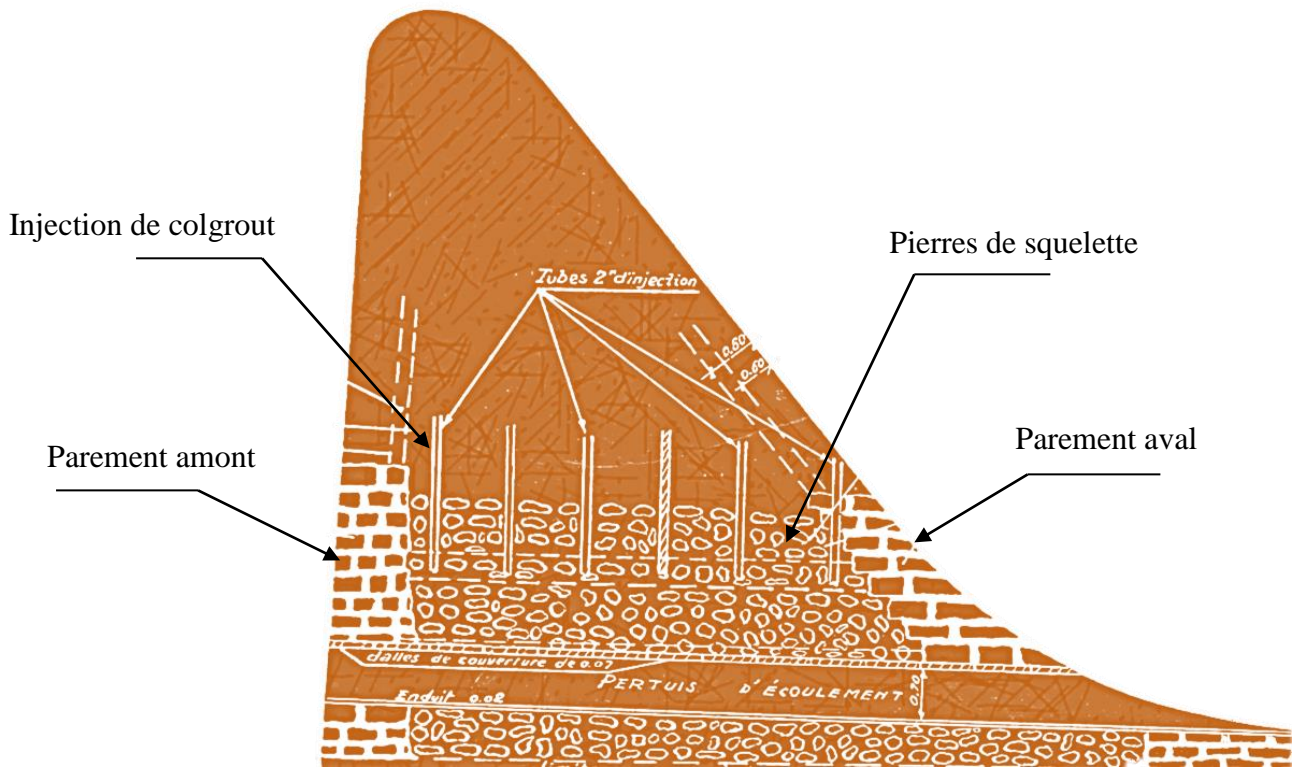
Schéma d'une coupe du barrage de Milok
